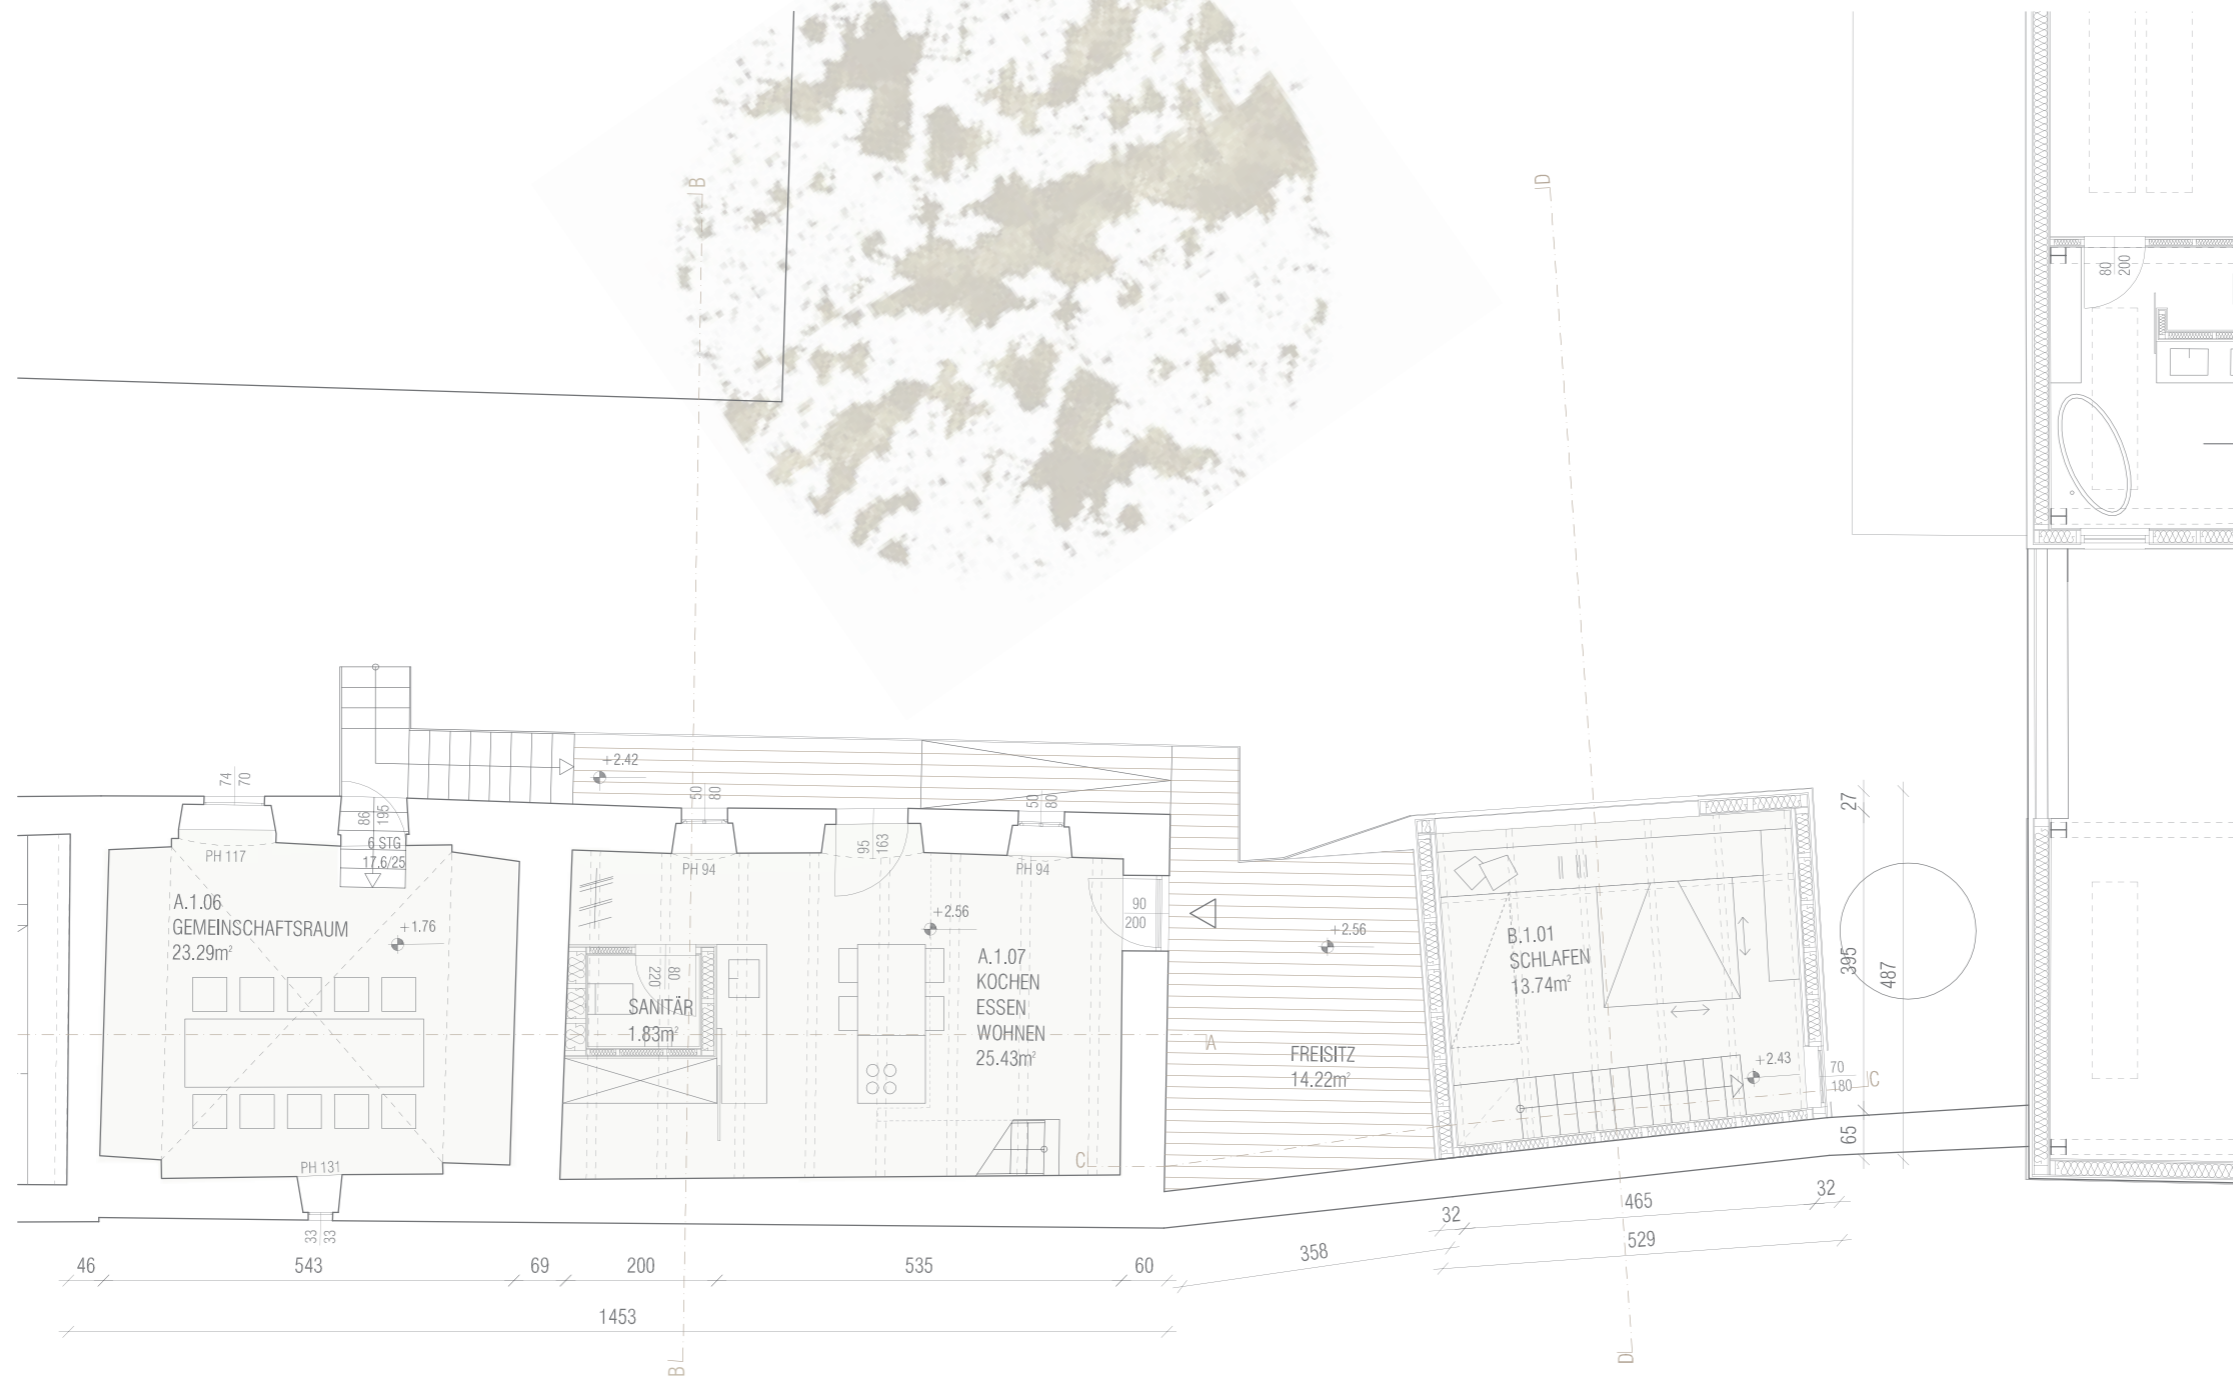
Gebäude A_WOCHENENDHAUS_Gebäude B_GÄSTEHAUS_Grundriss Obergeschoss Maßstab 1:100
